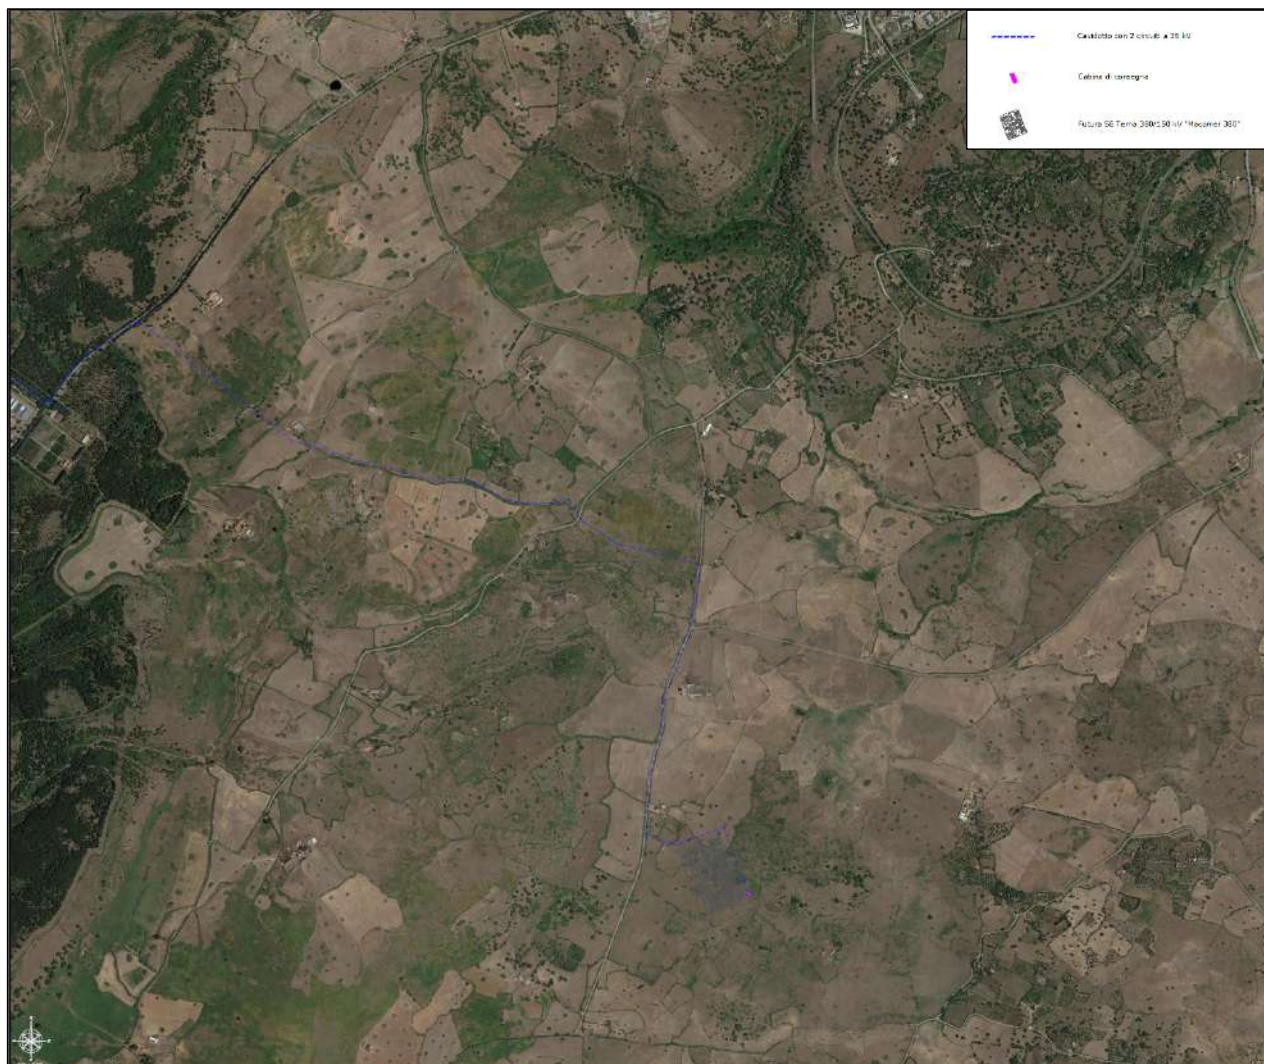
Vista in pianta dei cavidotti. Fonte: elaborato di progetto "C21BLN001DWD02900_ Planimetria cavidotti"
